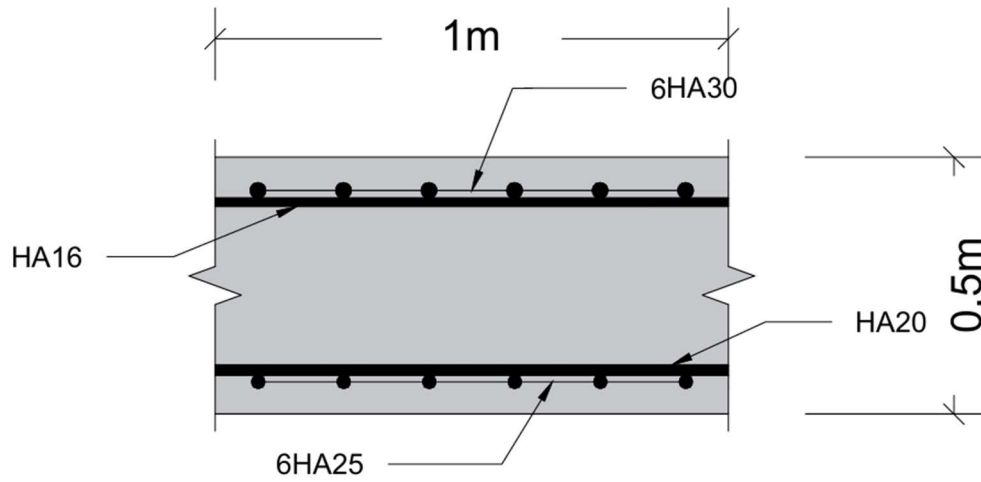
Ferrailage de la dalle du terre-plein coupe A-A.
